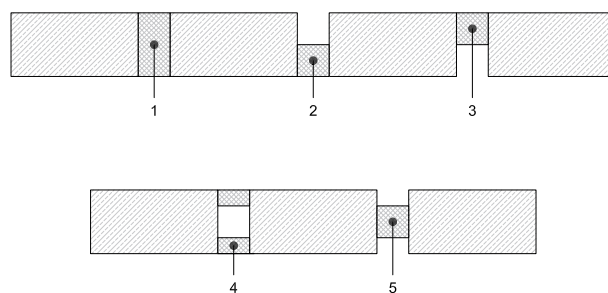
| Posizione delle protezioni antifuoco e applicabilità in cantiere
